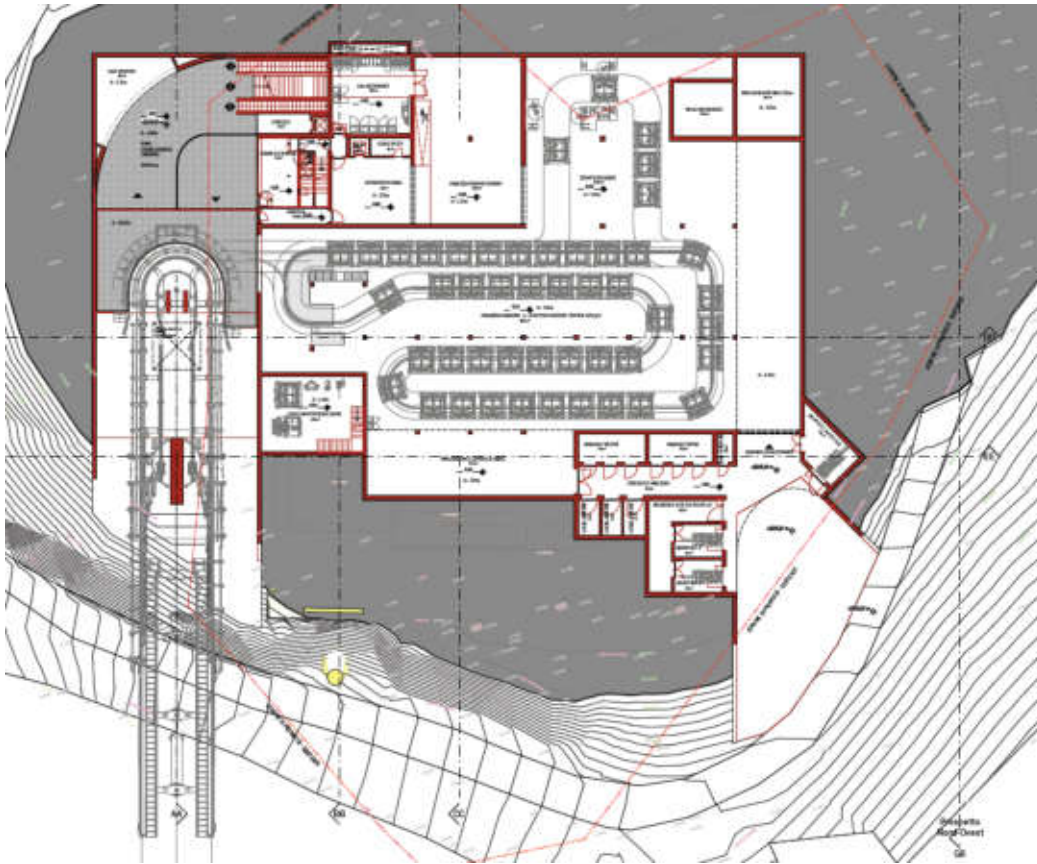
Projektauszug – Grundriss 2. UG Bergstation (Arch. Sader) / stralcio da progetto – pianta 2° piano interrato stazione di monte (Arch. Sader)
